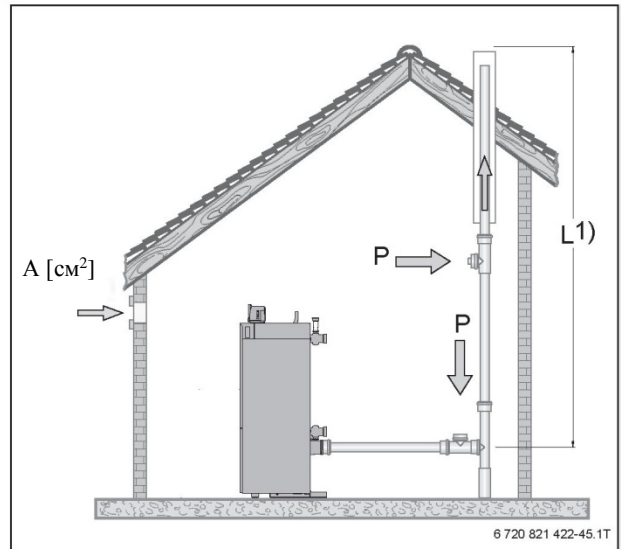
Пример расположения контрольного отверстия при горизонтальном трубопроводе отвода дымовых газов без поворота в помещении для установки (схематическое изображение)
